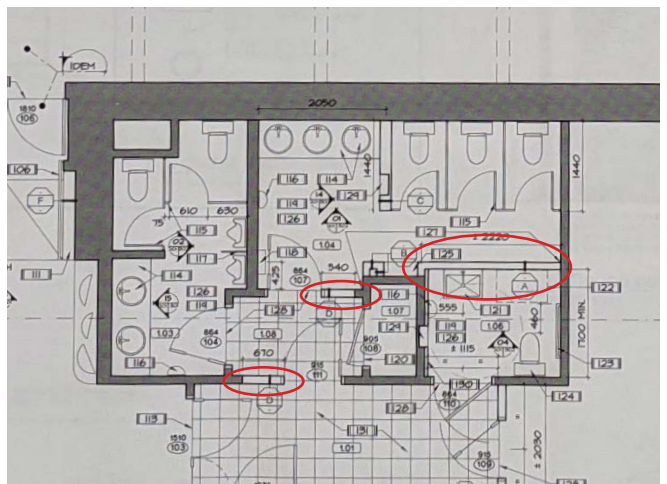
Plan des sanitaires. Source : Boudreau, Fortier et associés.
